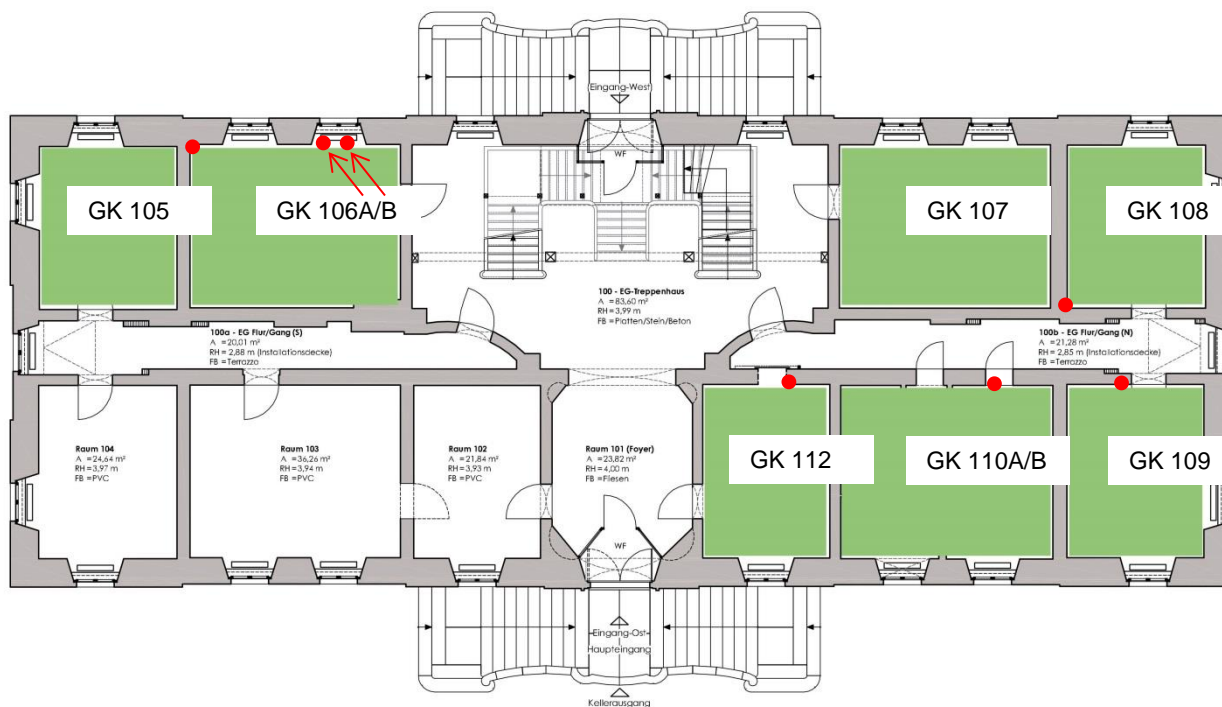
Grundriss EG, Probenahmepunkte
